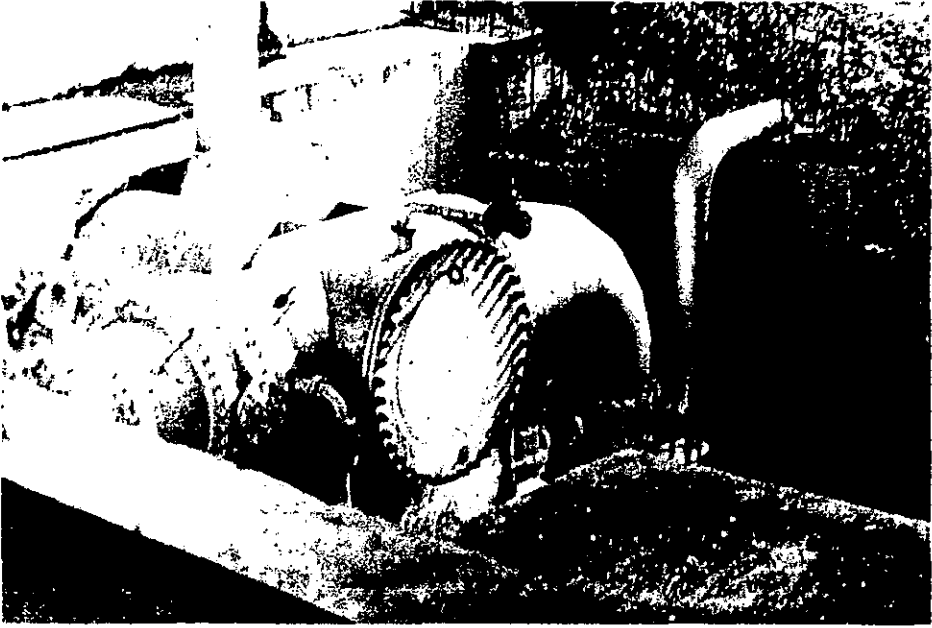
Subestructura construida para casa de máquinas. Caída "San Joaquín".
